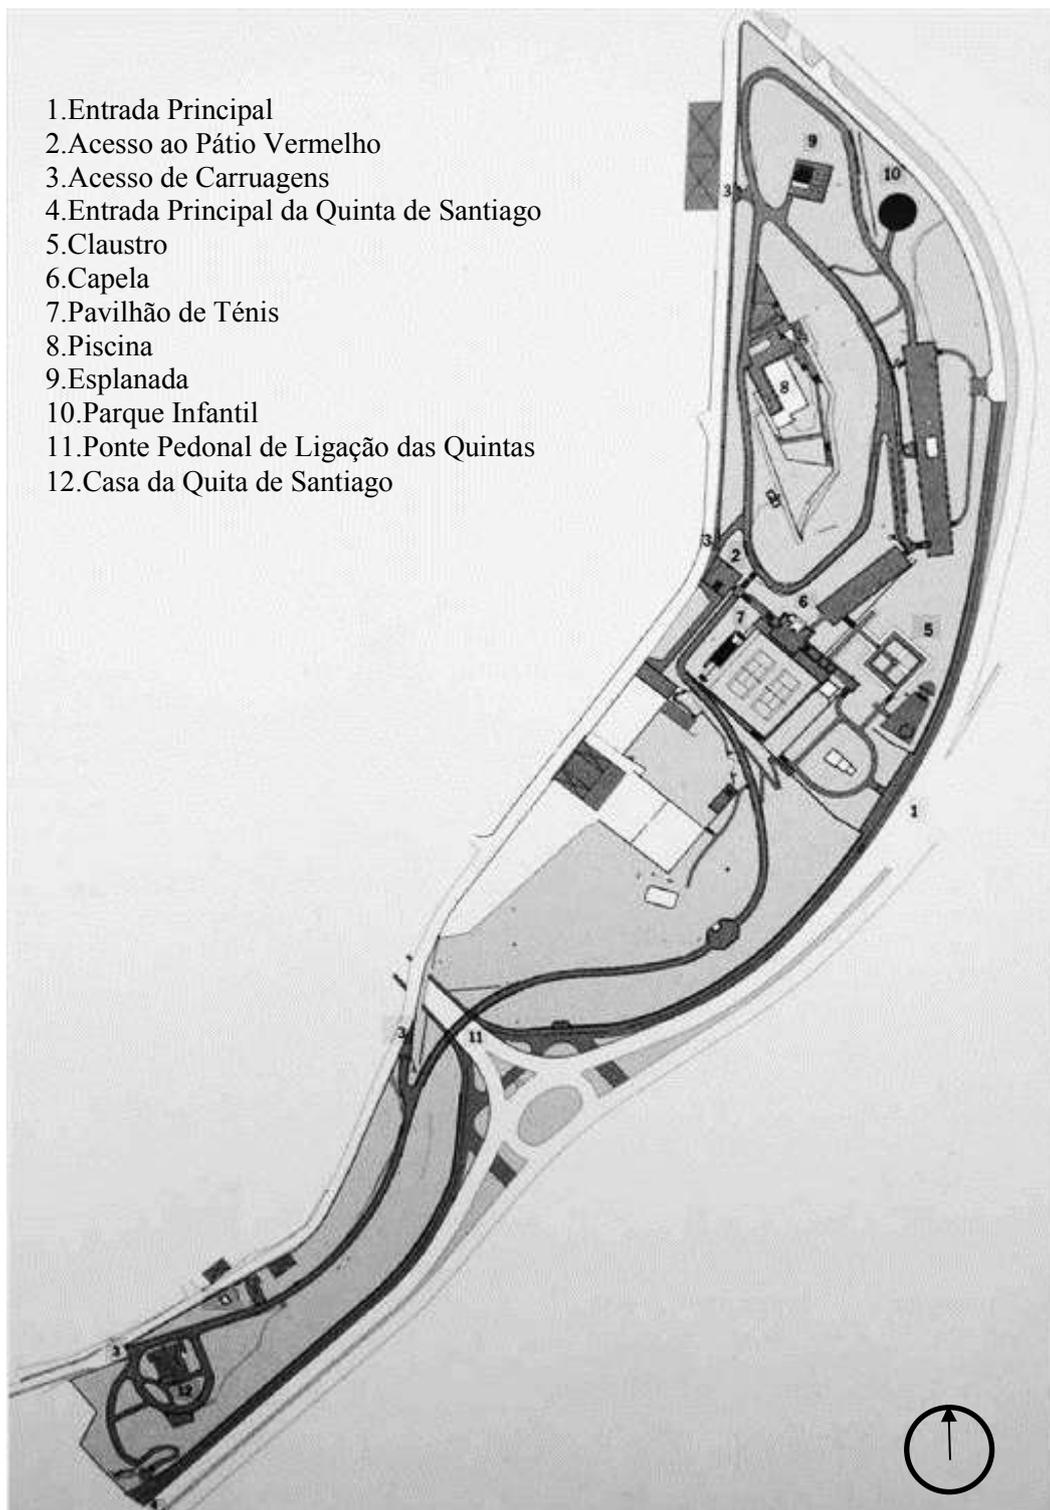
Planta da Quinta da Conceição (1958 - 60)
